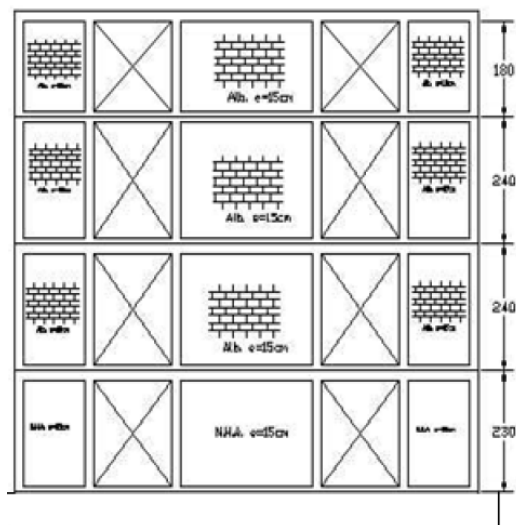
Planta tipo de los edificios de la Comunidad Andalucía. Fuente: (Andrade Trujillo, 2014)
